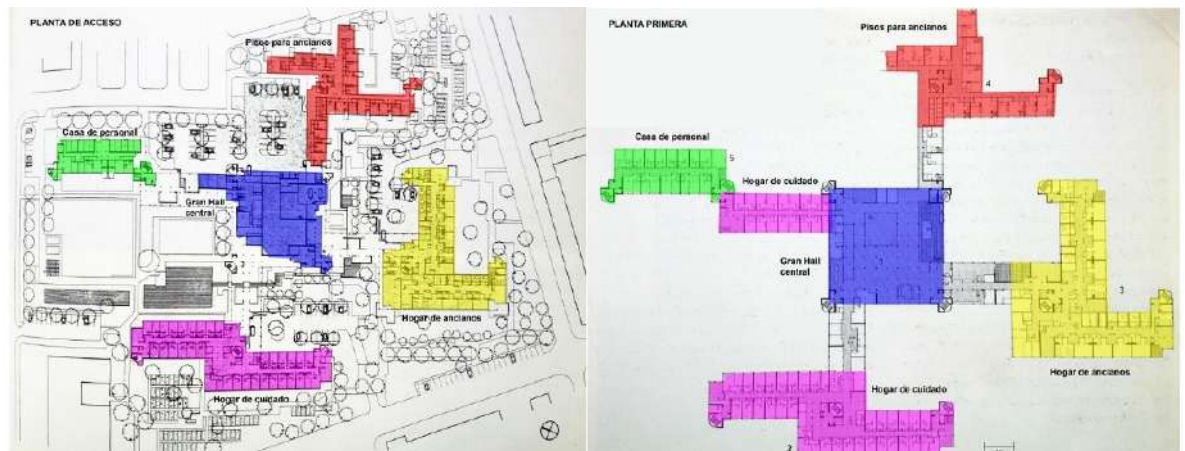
Organización funcional en planta de acceso y planta primera. Fuente: Sánchez, P.
